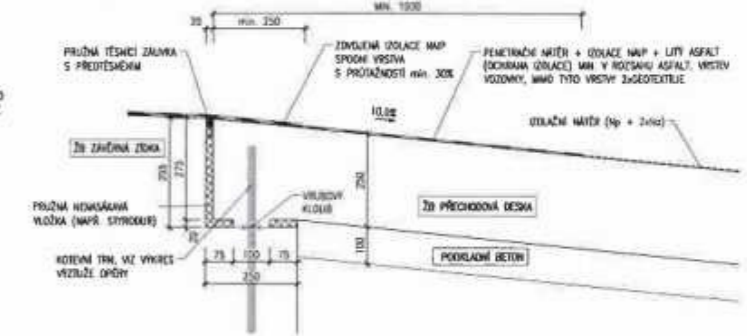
5 PŘÍČNÝ ŘEZ OPĚROU
